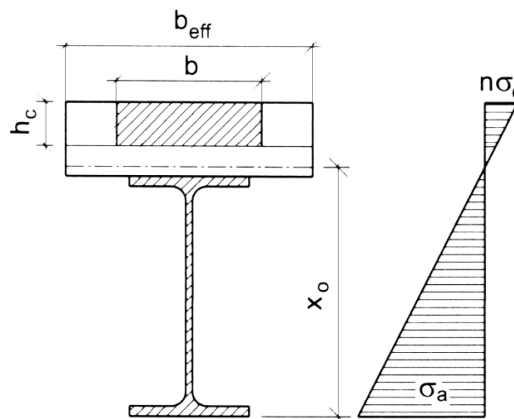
К определению положения нейтральной оси пролетного сечения без трещин в бетонной плите
